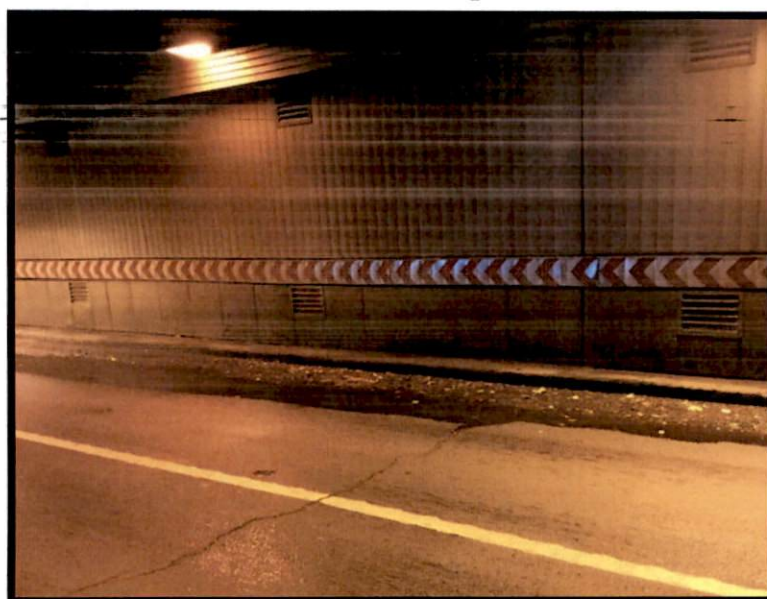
Degradarea rostului. Infiltrații în zona rostului
